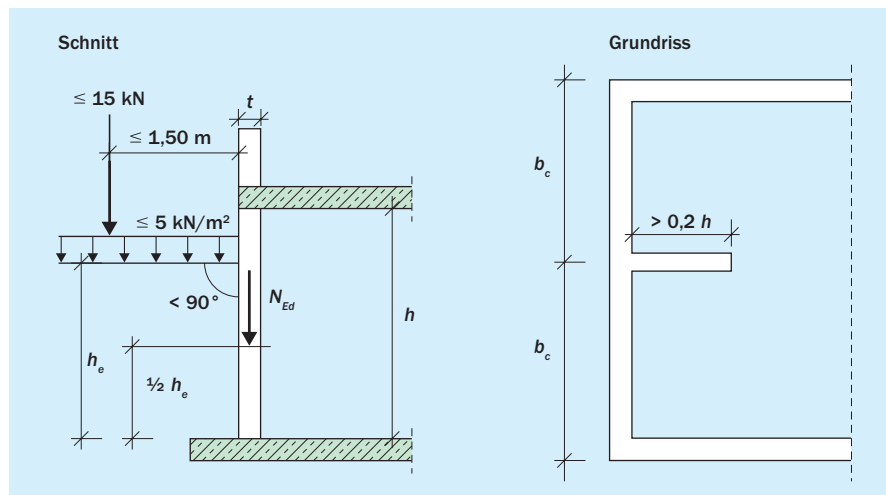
Nachweis von Kellerwänden nach DIN EN 1996-3/NA
